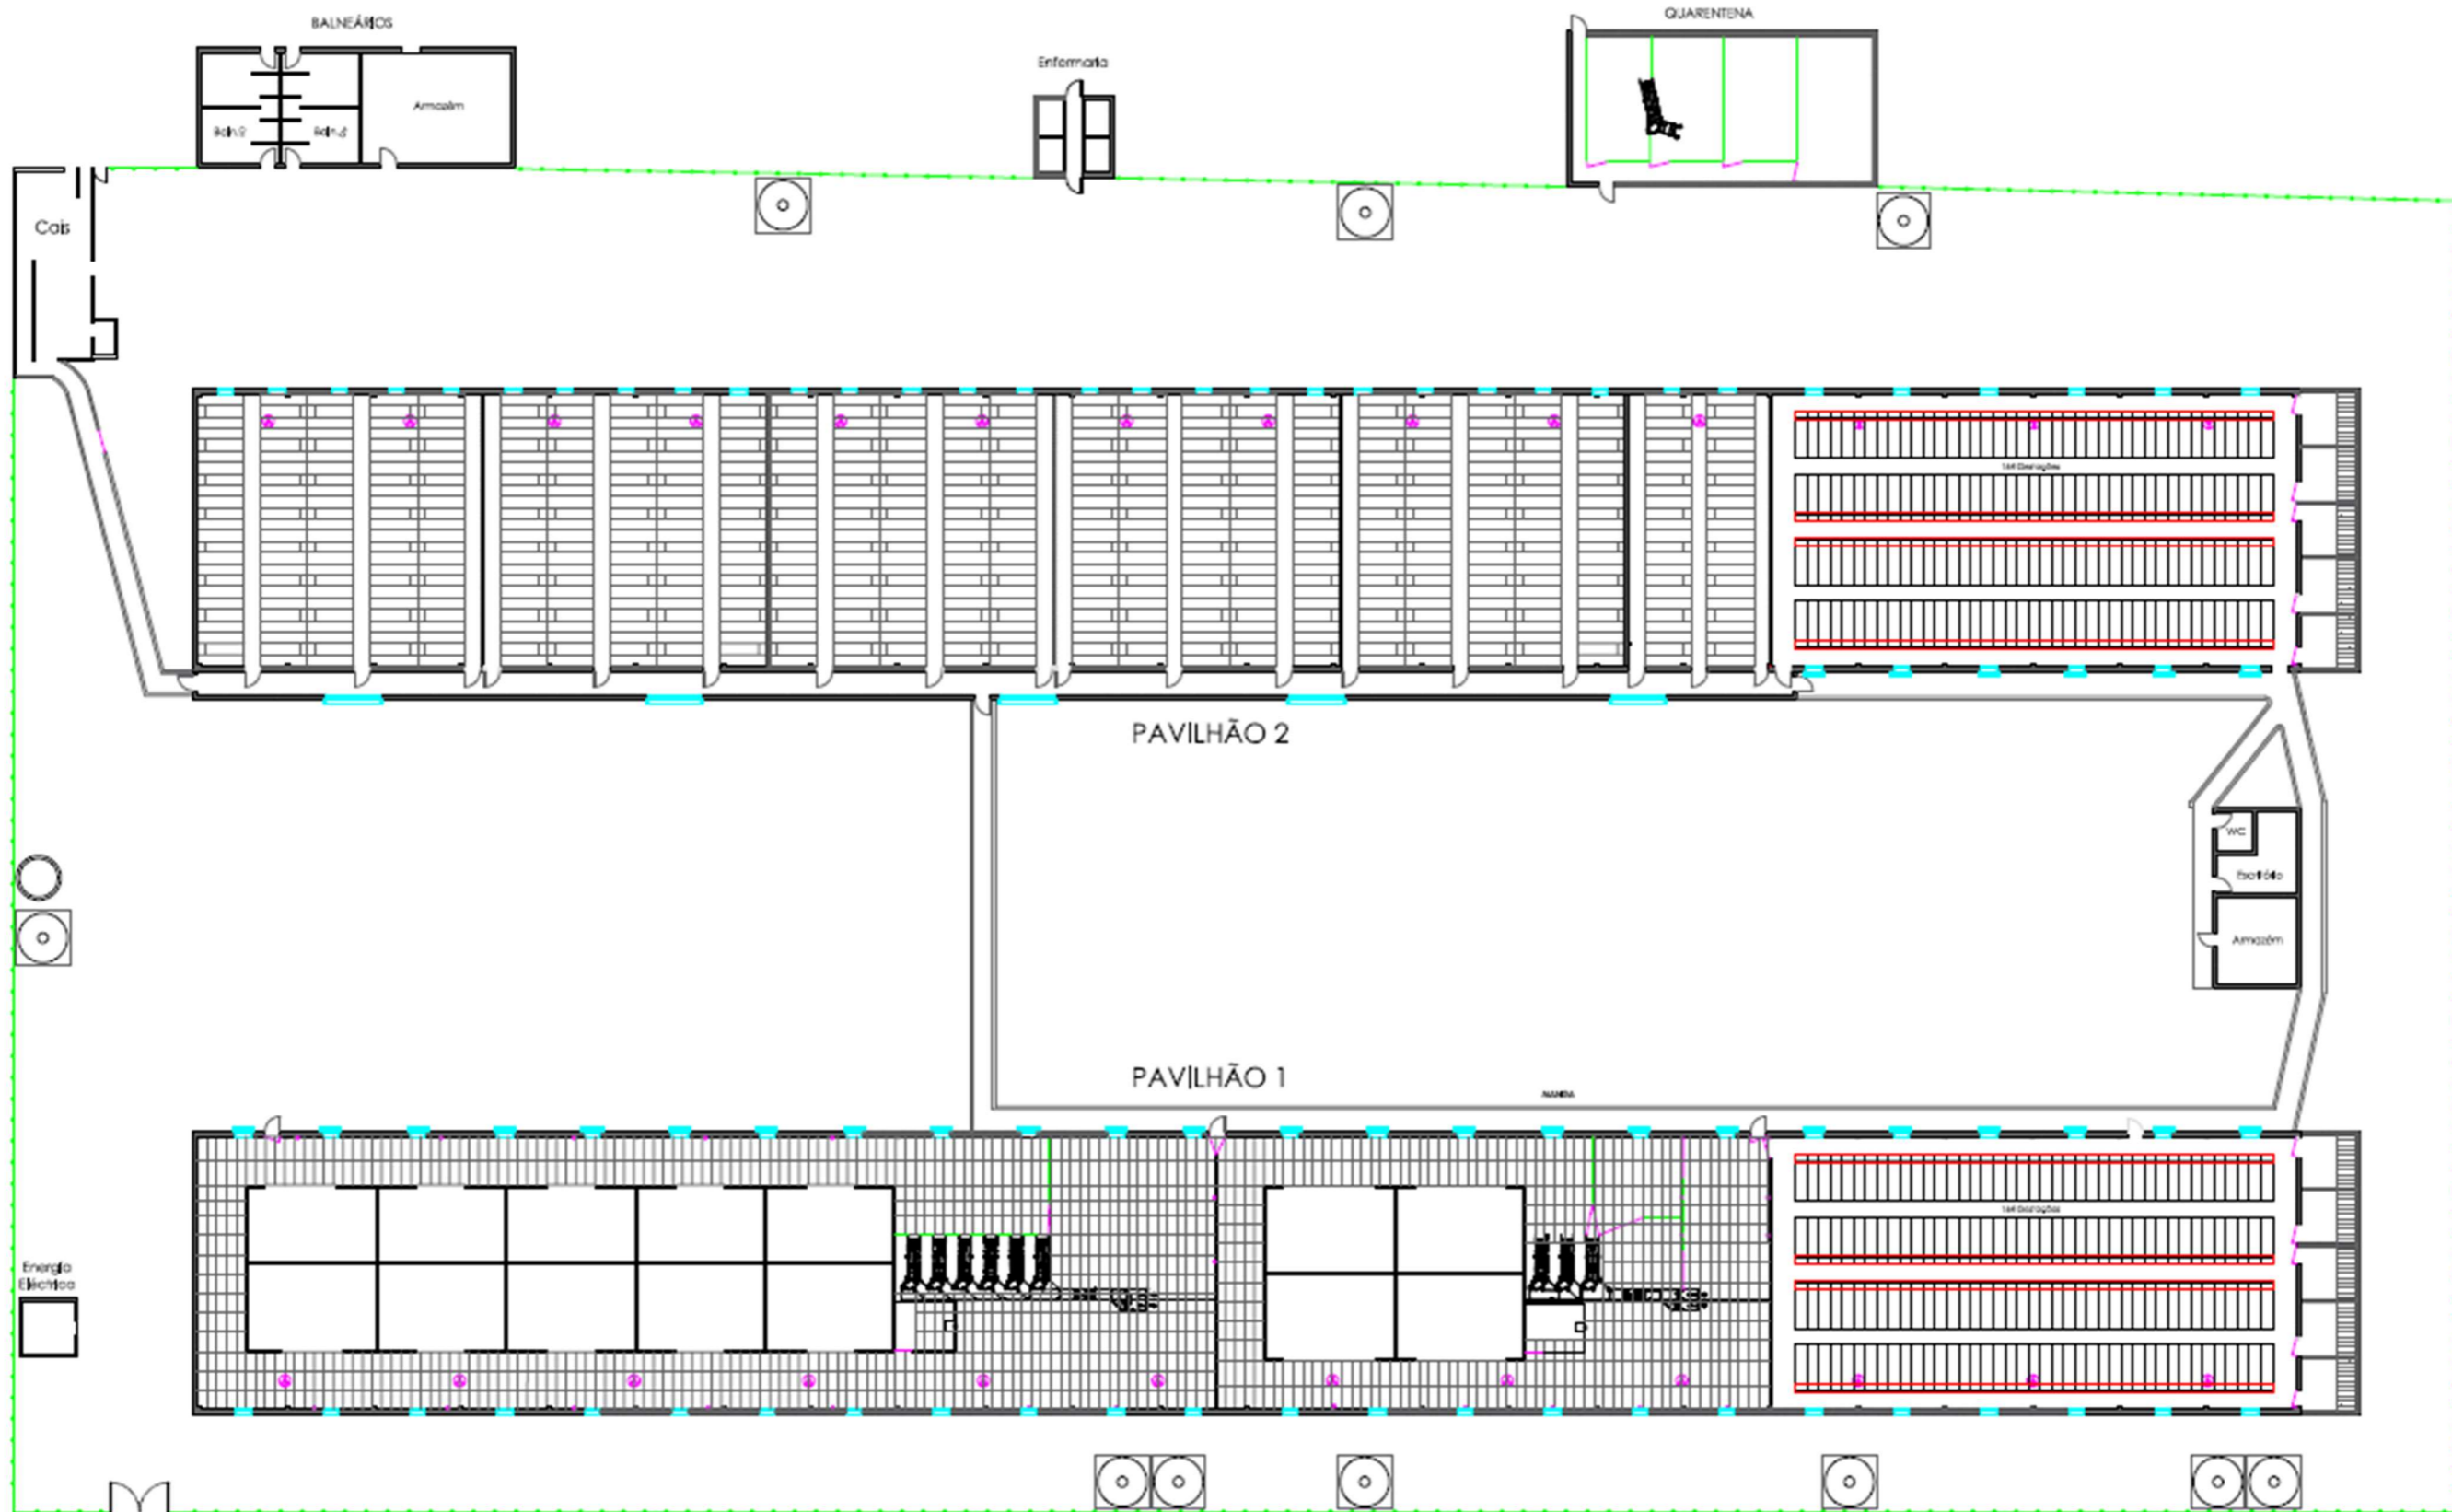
Extrato da planta de implantação da exploração pecuária de Cabrins.
